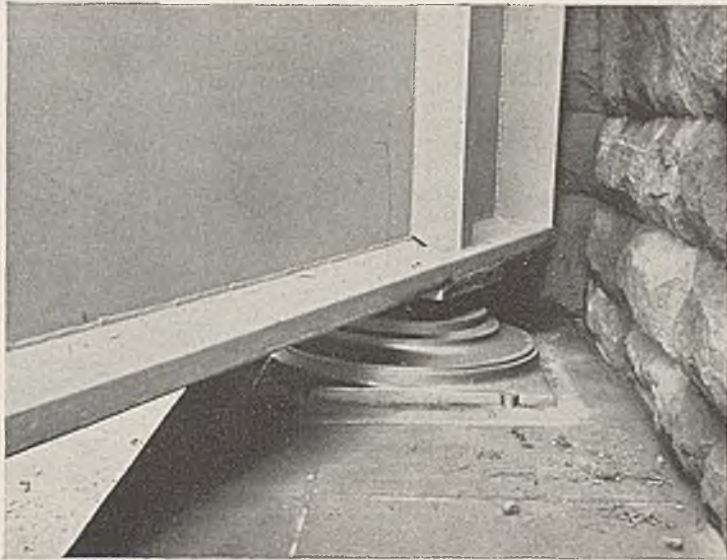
Allseitig bewegliches Hauptlager im Bauwerk.
